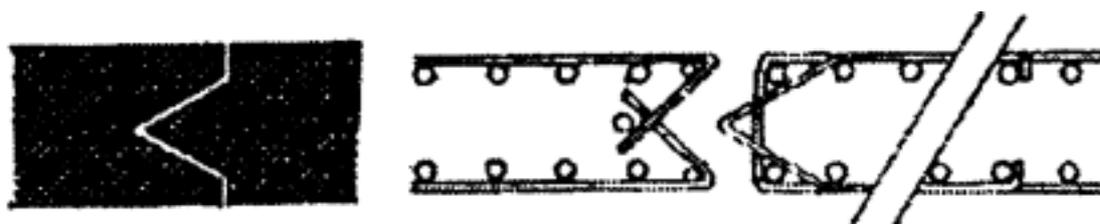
Juntas trapezoidales y armado tipo ( Vicente Ordura Vial, 2015)
